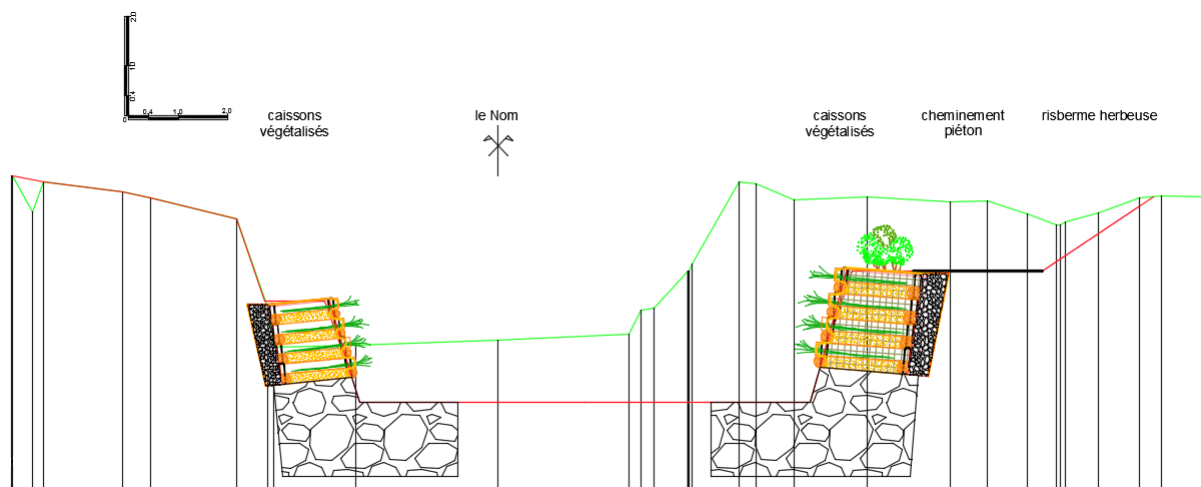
Coupe type de la risberme et des protections de berges du secteur nouveau pont-passerelle projet 2018
